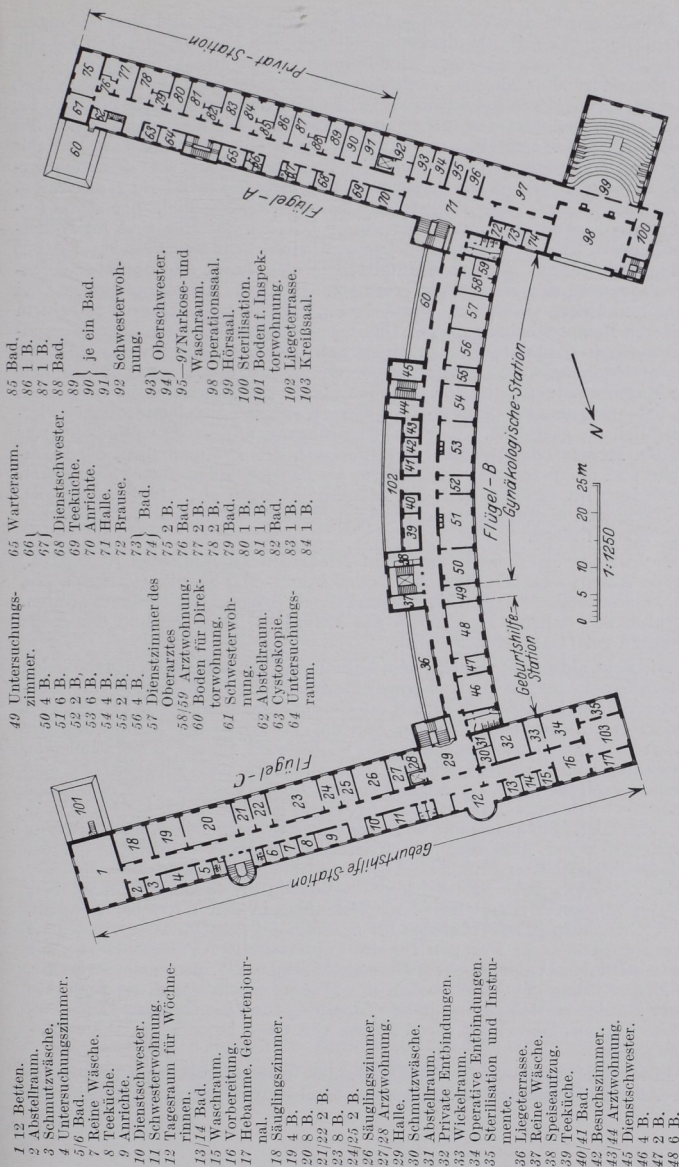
Grundriß vom 2. Obergeschoß des Hauptgebäudes der Universitätsfrauenklinik Leipzig.
